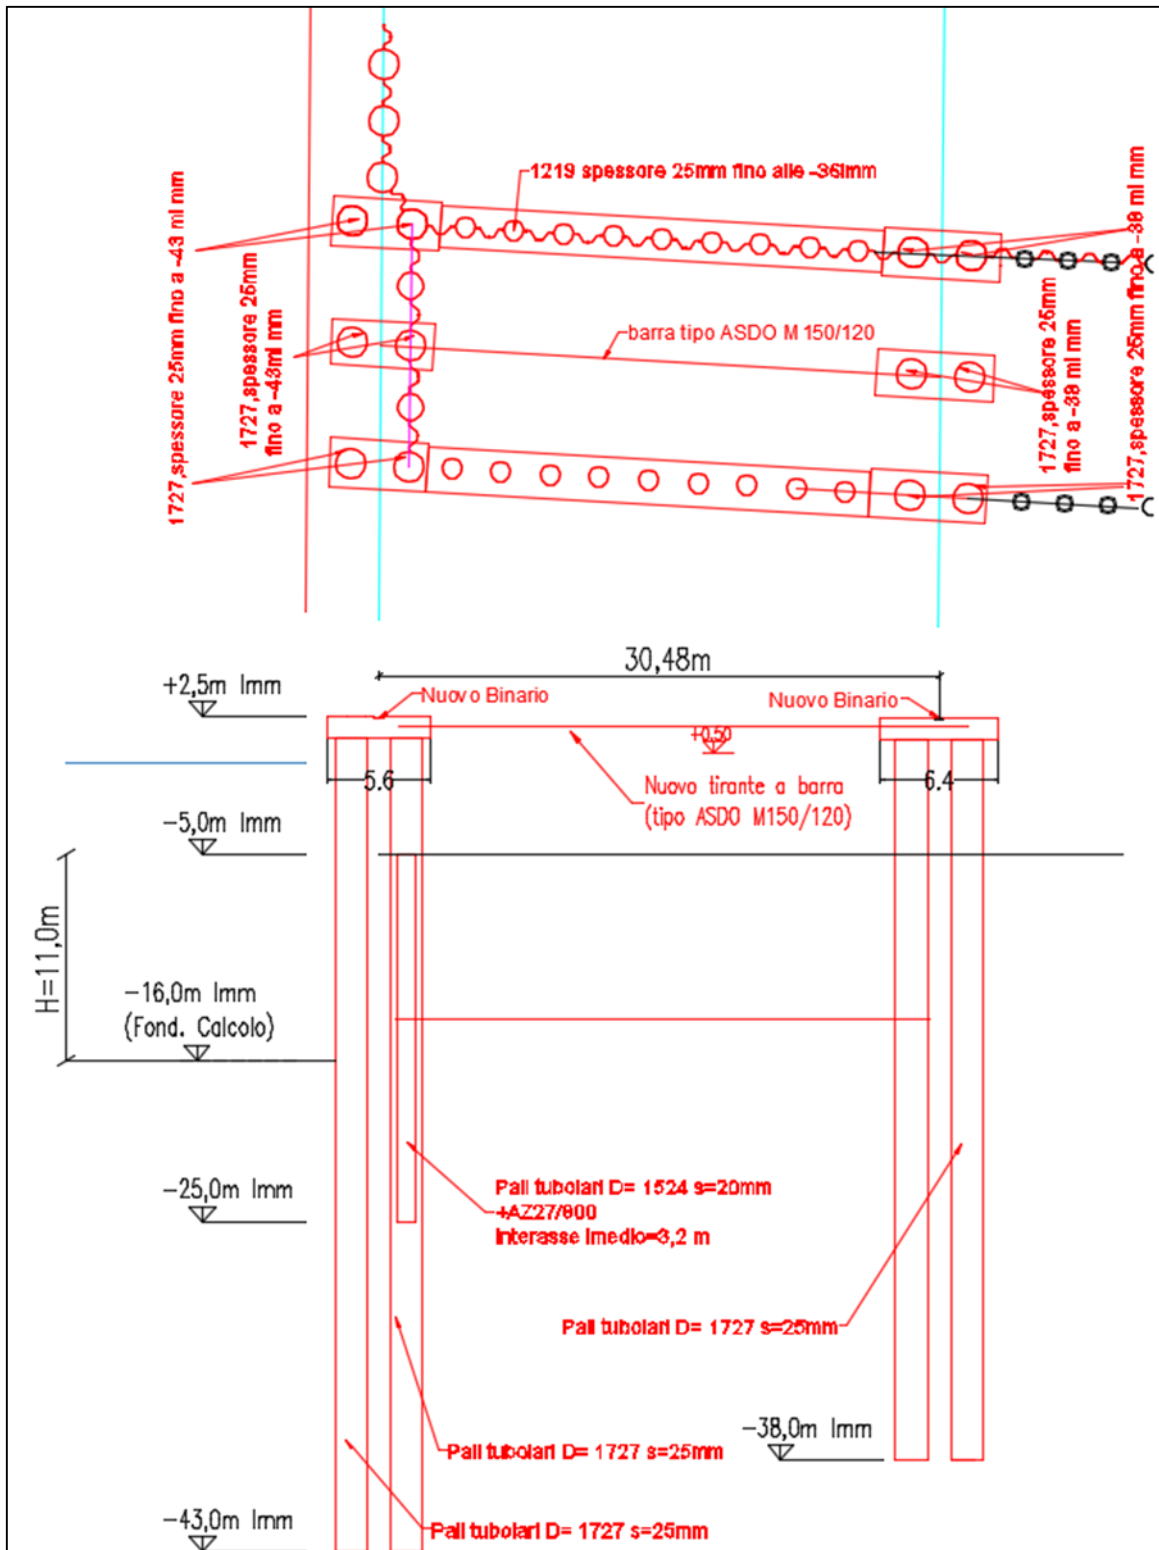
Nuovo Ravano (Melara): sezione rappresentativa dell'intervento
